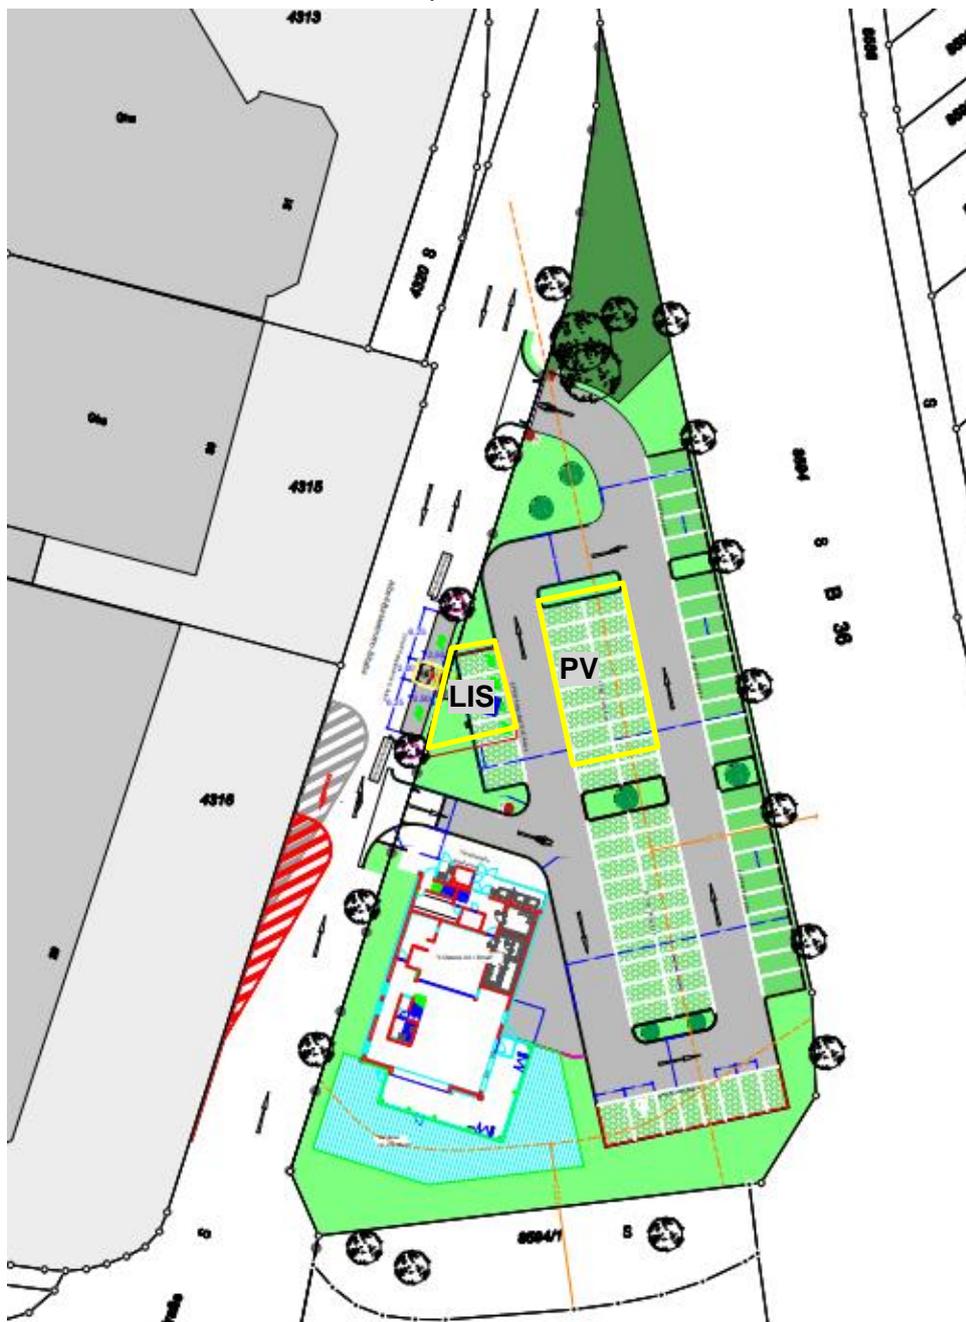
Layoutplan des Vorhabengrundstücks (Quelle: MVV Regioplan, eigene Darstellung, Kartengrundlage LUBW).
